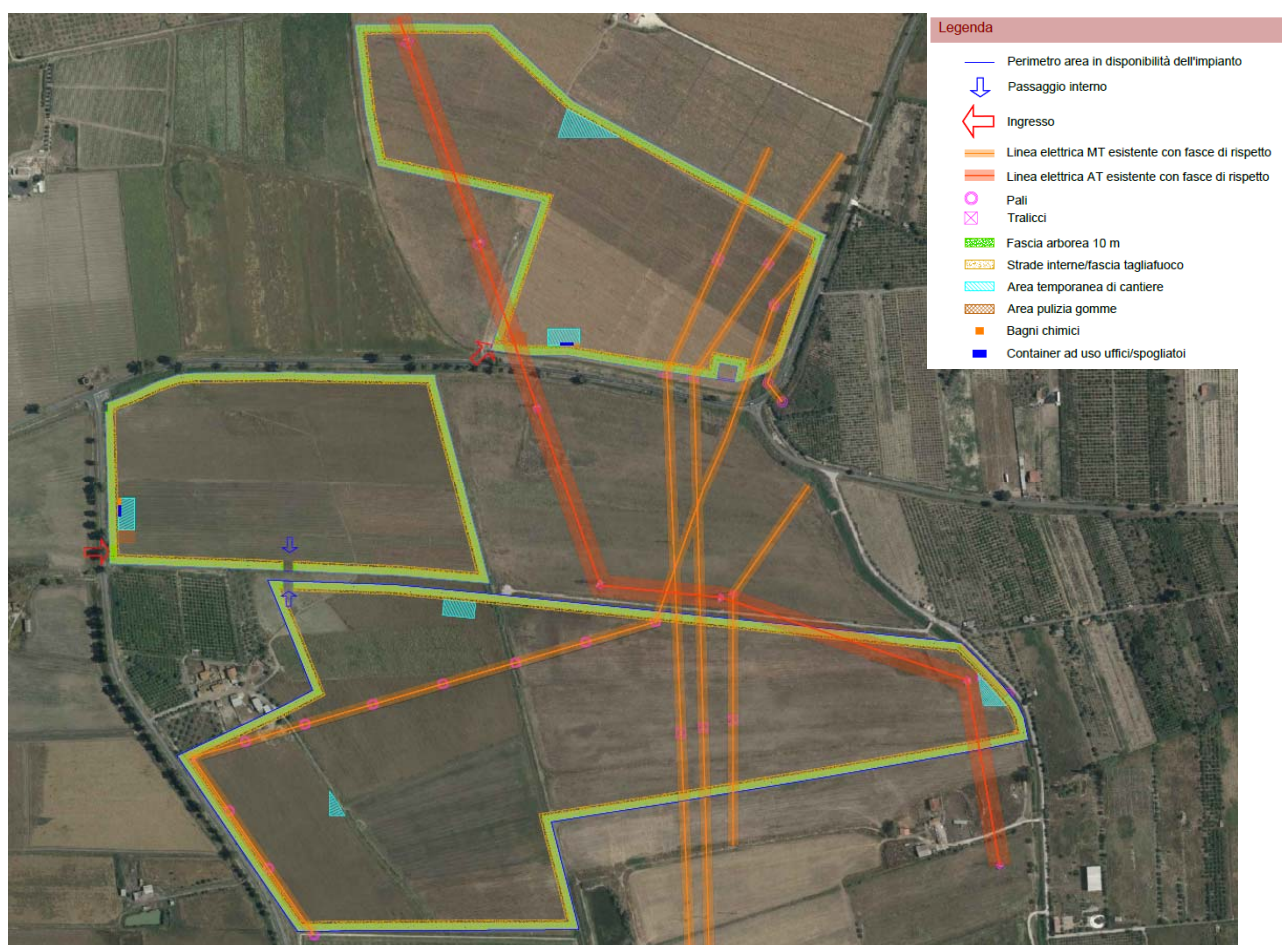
Planimetria del sito estratta dall’elaborato *T12\_Layout\_impianto\_FV\_ree\_stoccaggio\_cantiere
